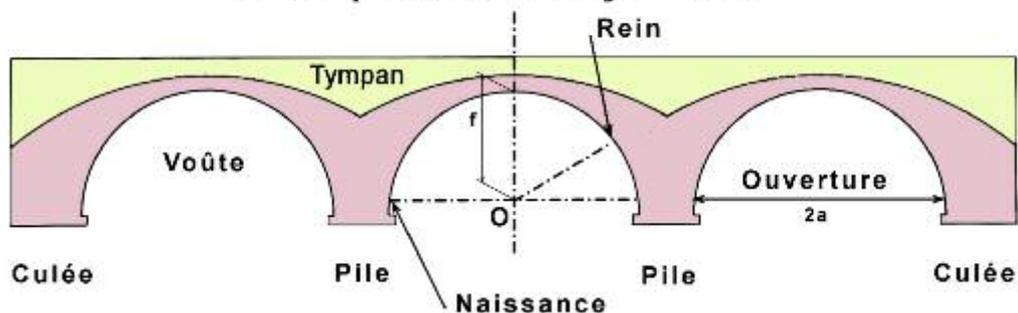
coupe longitudinale schématique d'un pont en maçonnerie
